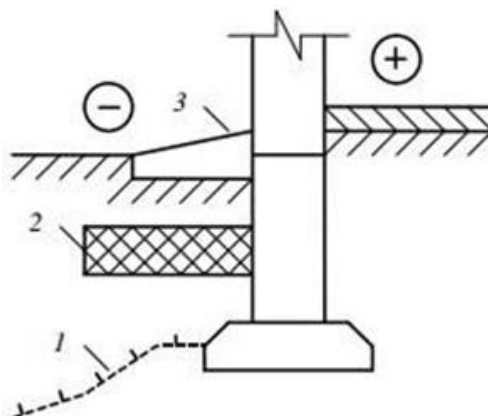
Теплова ізоляція ґрунту біля фундаменту:
